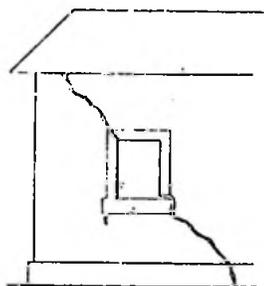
Fissuras típicas de recalques numa esquina da construção
